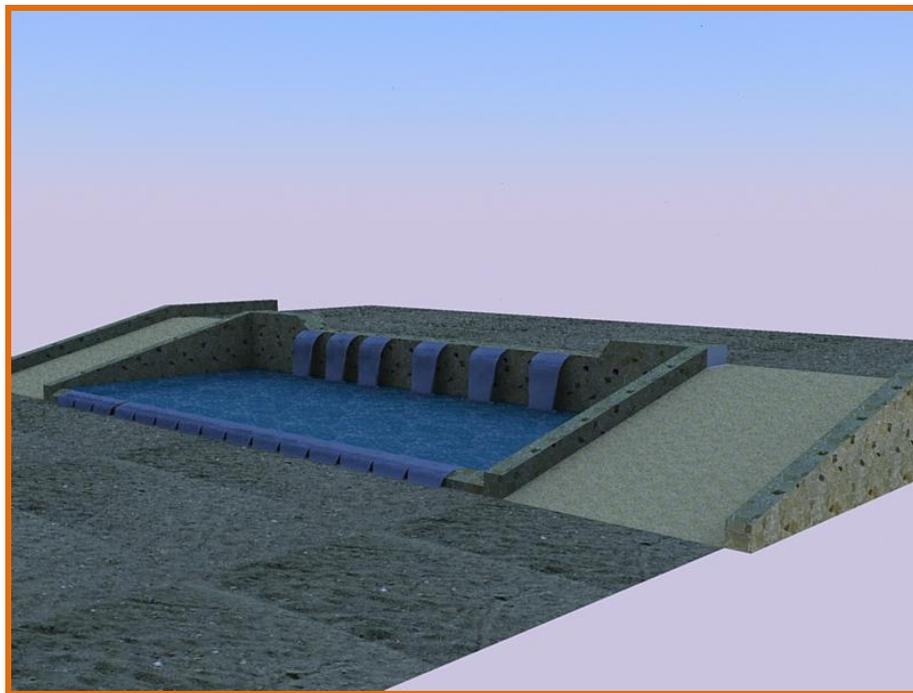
, Modelo de dique a utilizar en la Propuesta N° 1, compuesto de rampas de acceso.
